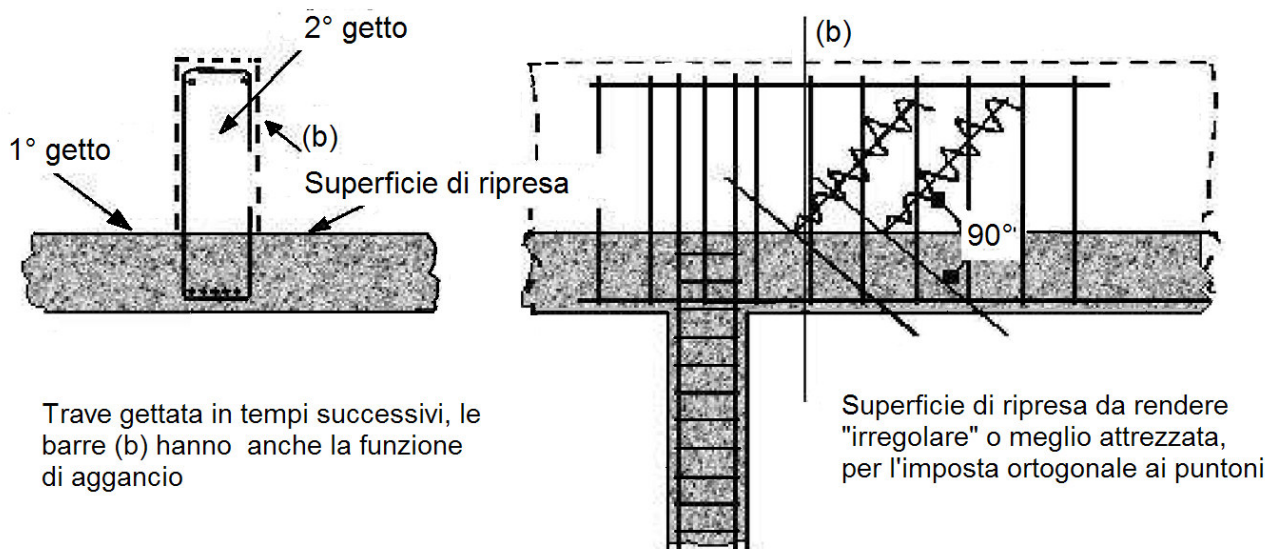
Modalità di ripresa del getto in travi di piano e di fondazione
